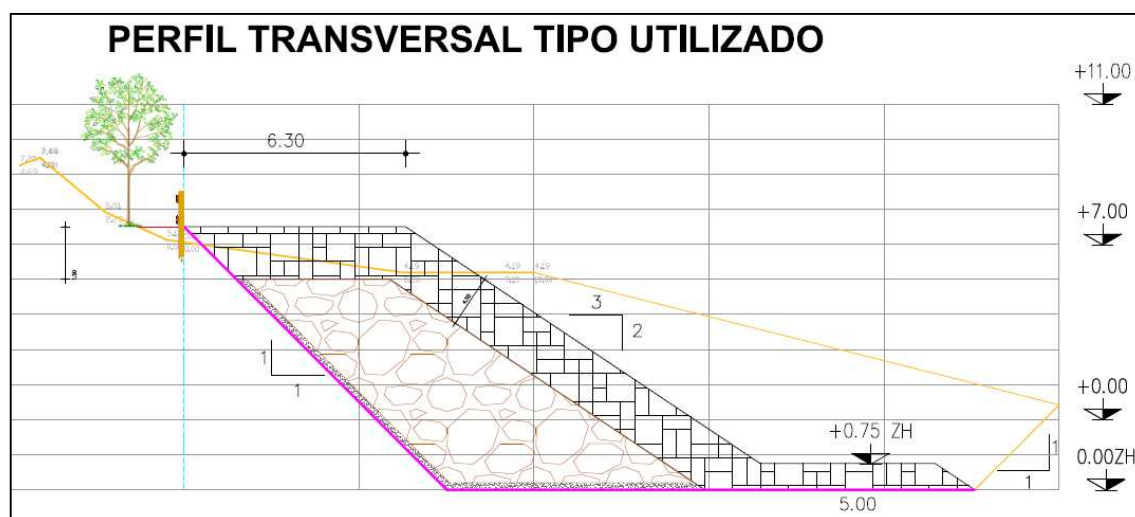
Perfil tipo (fonte: APA – ARH Centro, maio de 2012)
